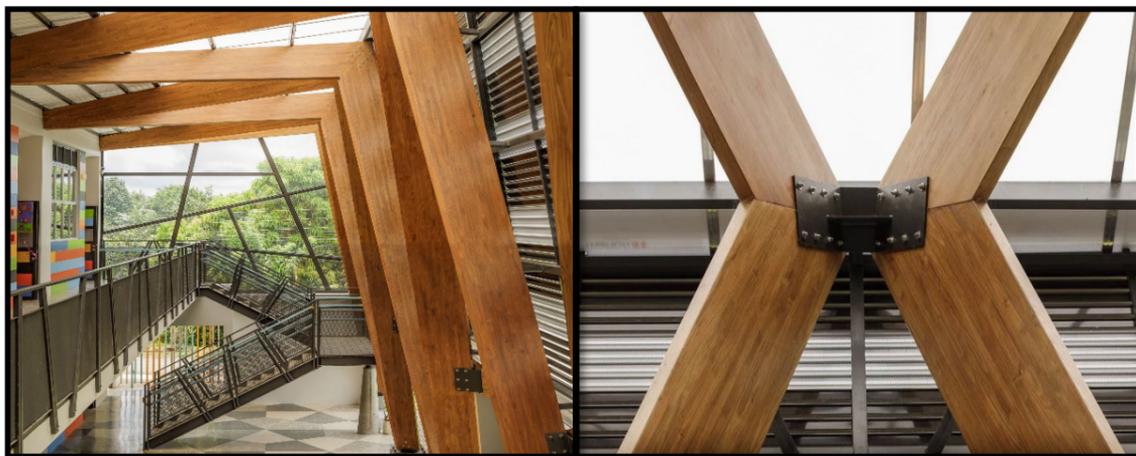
Aspectos constructivos. Fuente: <https://www.nortesurararquitectos.com/escuelasectorangeles> Ilustración 50 Aspectos constructivos. Fuente: <https://www.nortesurararquitectos.com/escuelasectorangeles>
